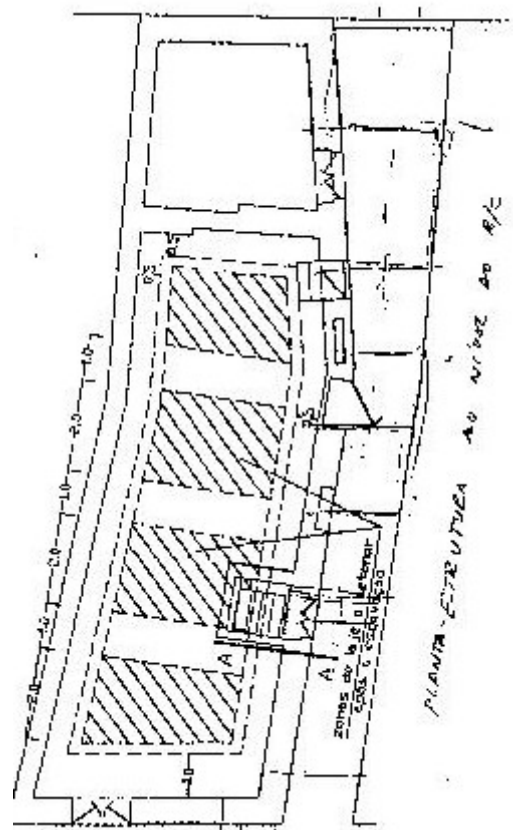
Implantação de viga de cintagem e faixas de laje com 1.00 m
